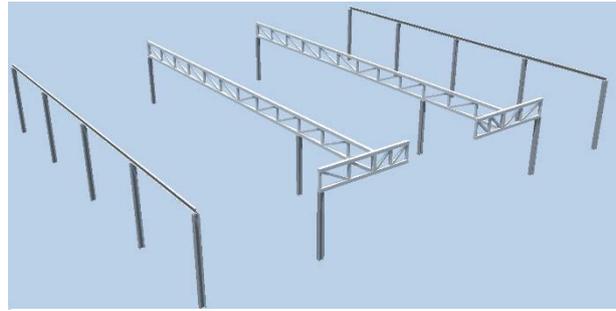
Animación de estructura de Planta Primera, extraída del modelo. En ésta se observa la disposición de las vigas y las cerchas metálicas existentes en dicha planta. (Elaboración propia, Allplan 2015).
